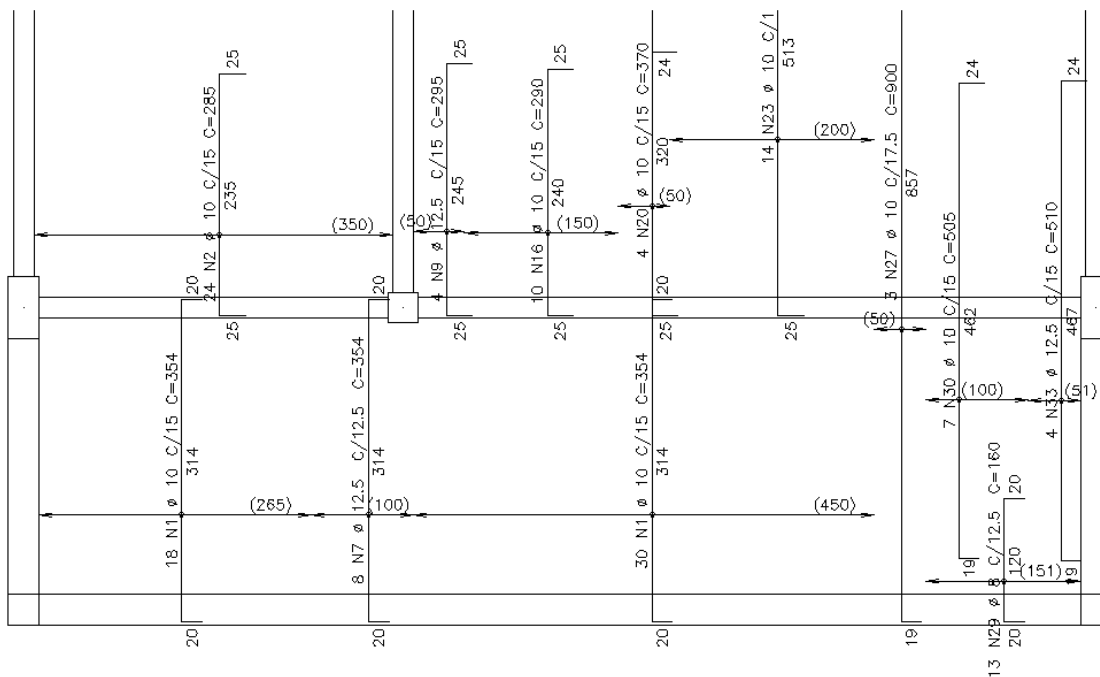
Armaduras verticais negativas nas lajes L10, L11 e L12 do pavimento Biblioteca da
